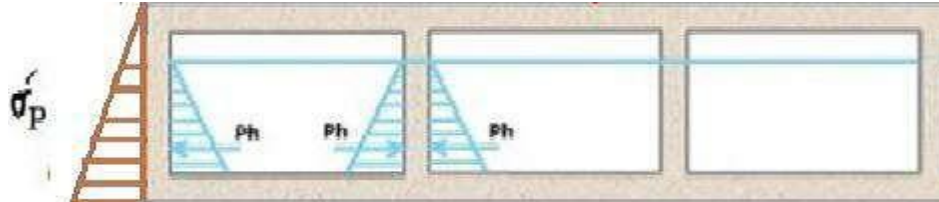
L'action de la poussée des terres sur le dalot.
